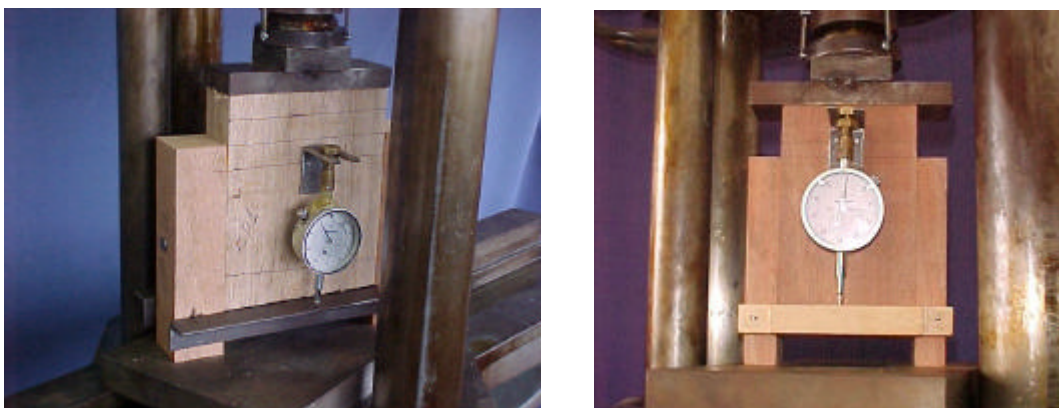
Configuração do ensaio de ligação para corpo-de-prova tipo 1 e 2.
